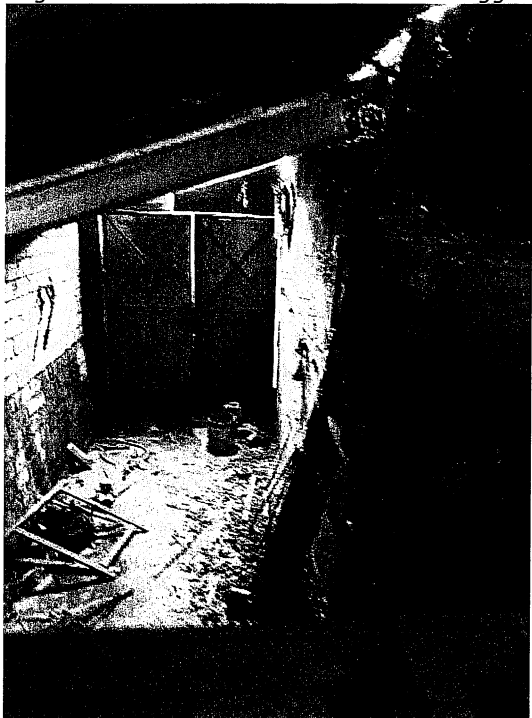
Vista interna della porzione ripostiglio nel fabbricato ex autolavaggio
